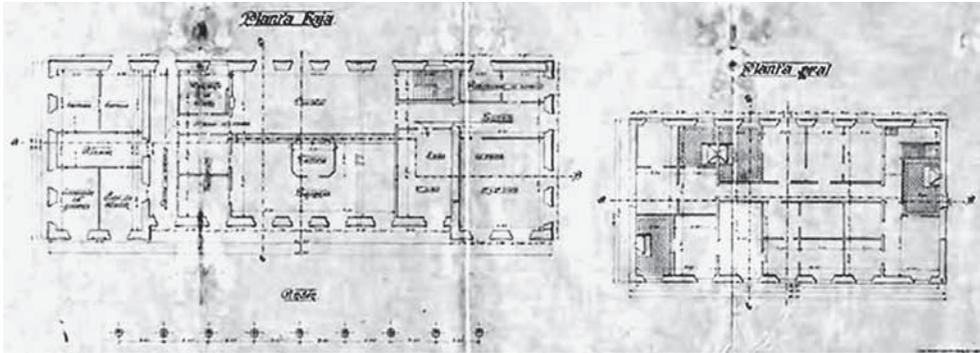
Plantas de la estación de Cornes. Archivo Municipal
